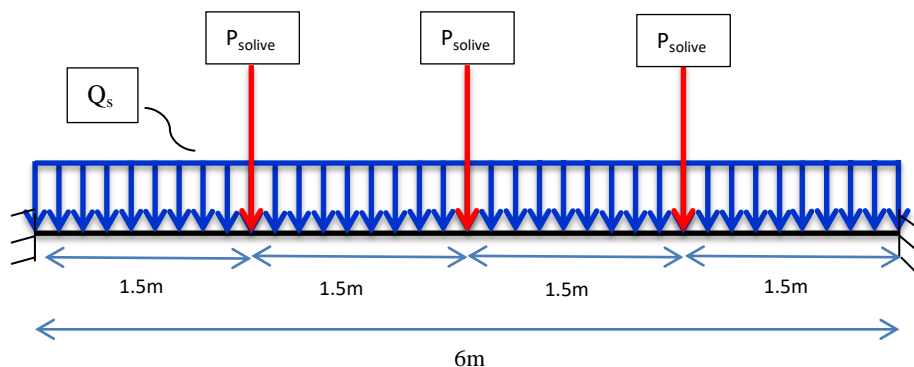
Schéma statique de la poutre maîtresse sous chargement
